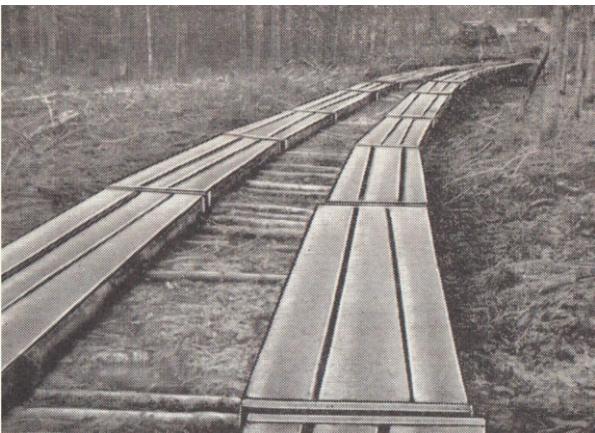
Лесовозный ус с покрытием из деревянных щитов
